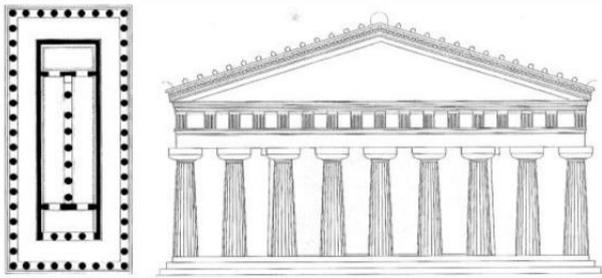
Grundriss und Frontalansicht Hera-Tempel
